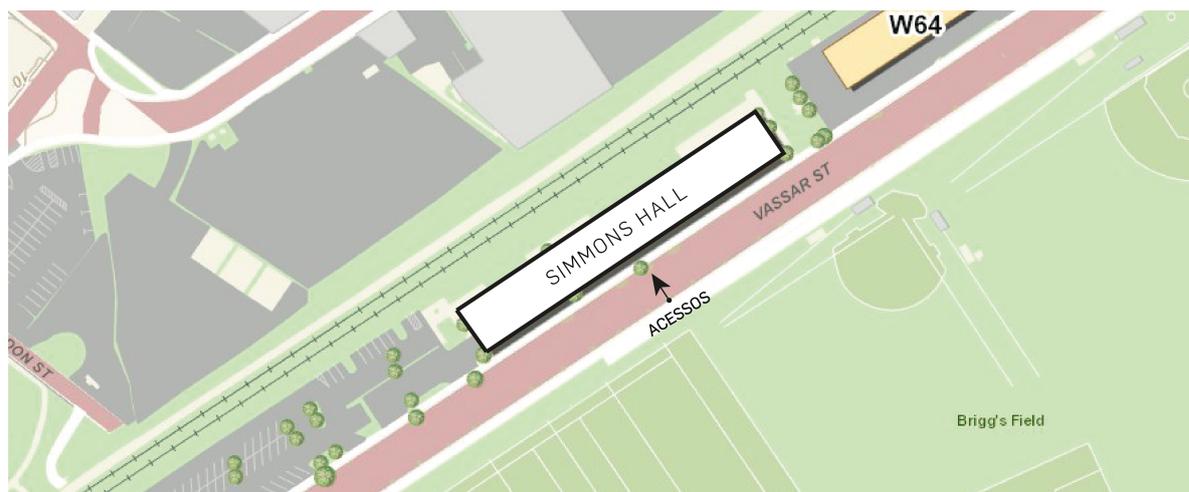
IMPLANTAÇÃO (SIMMONS HALL)
